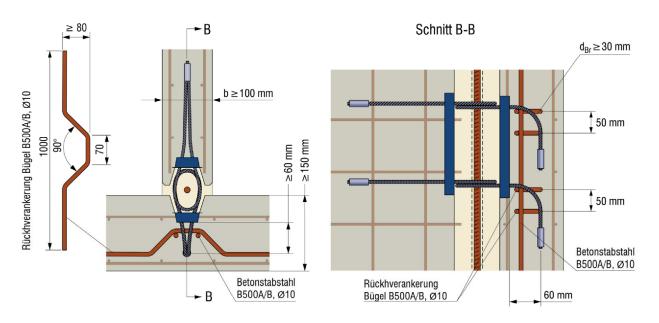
Wand - Wand - T-Verbindung - Detail mit abgewinkelten Seilschlaufen
